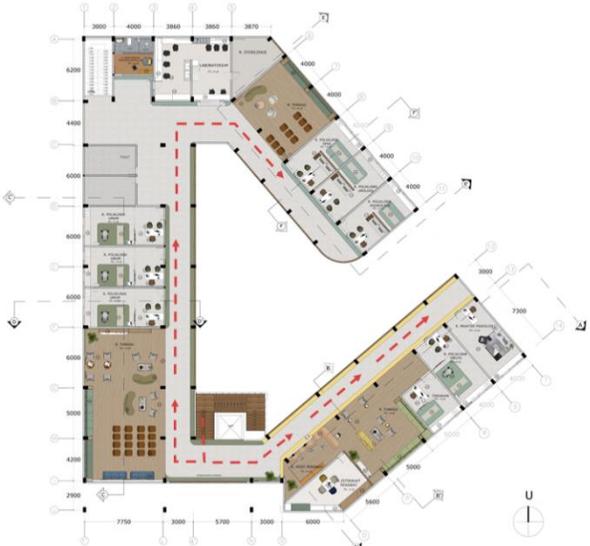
16 Penerapan Furnitur pada area Ruang Tunggu
